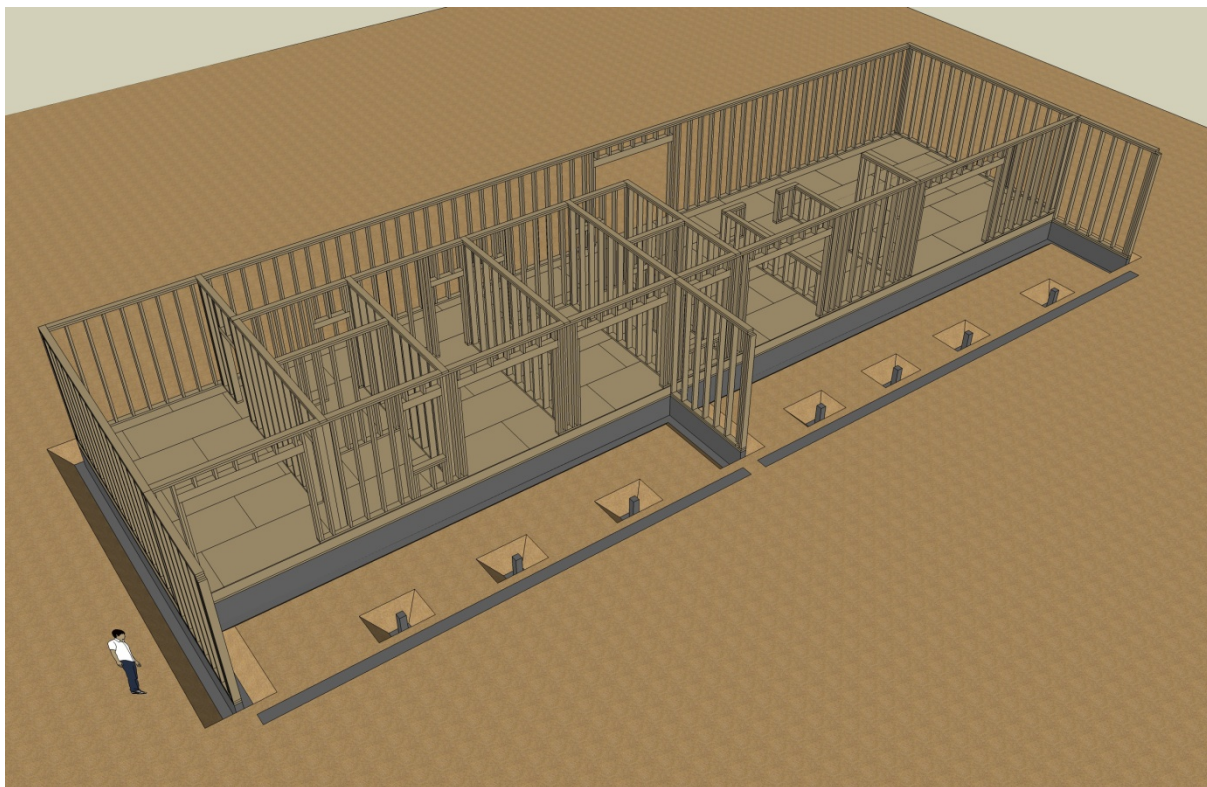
Montagem das paredes interiores no sentido longitudinal e respectivo travamento às outras paredes.
